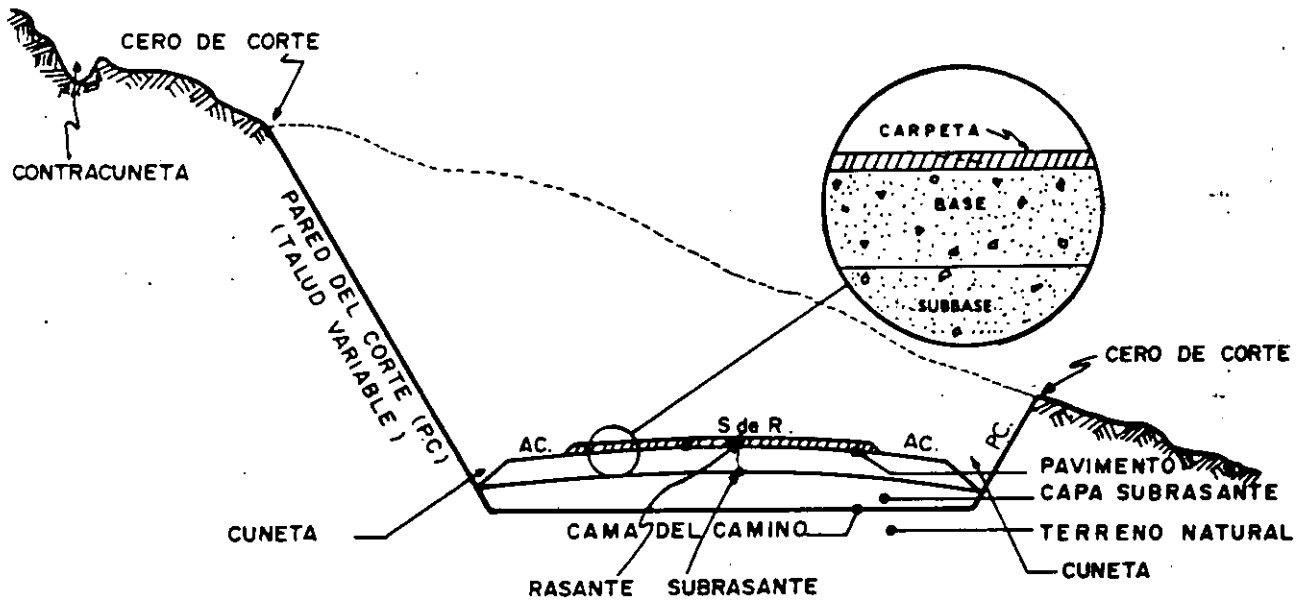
Sección transversal típica en corte, para carreteras de dos carriles; se muestra un detalle de pavimento flexible.
